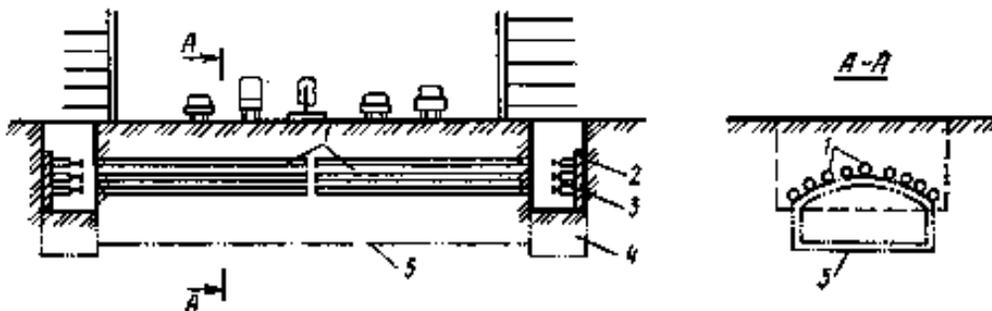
Схема экрана из труб над строящимся тоннелем: 1 – экран из труб; 2 – упор; 3 – домкраты; 4 – котлован; 5 – контур тоннеля
